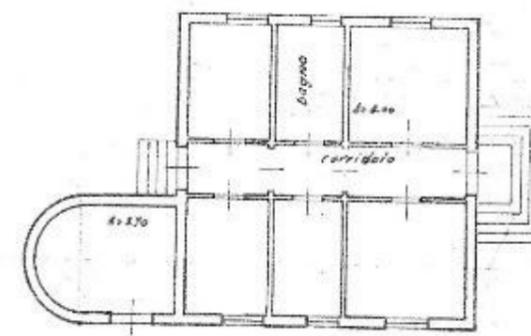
Fabbricato Part. 16. Planimetria Piano Terra
